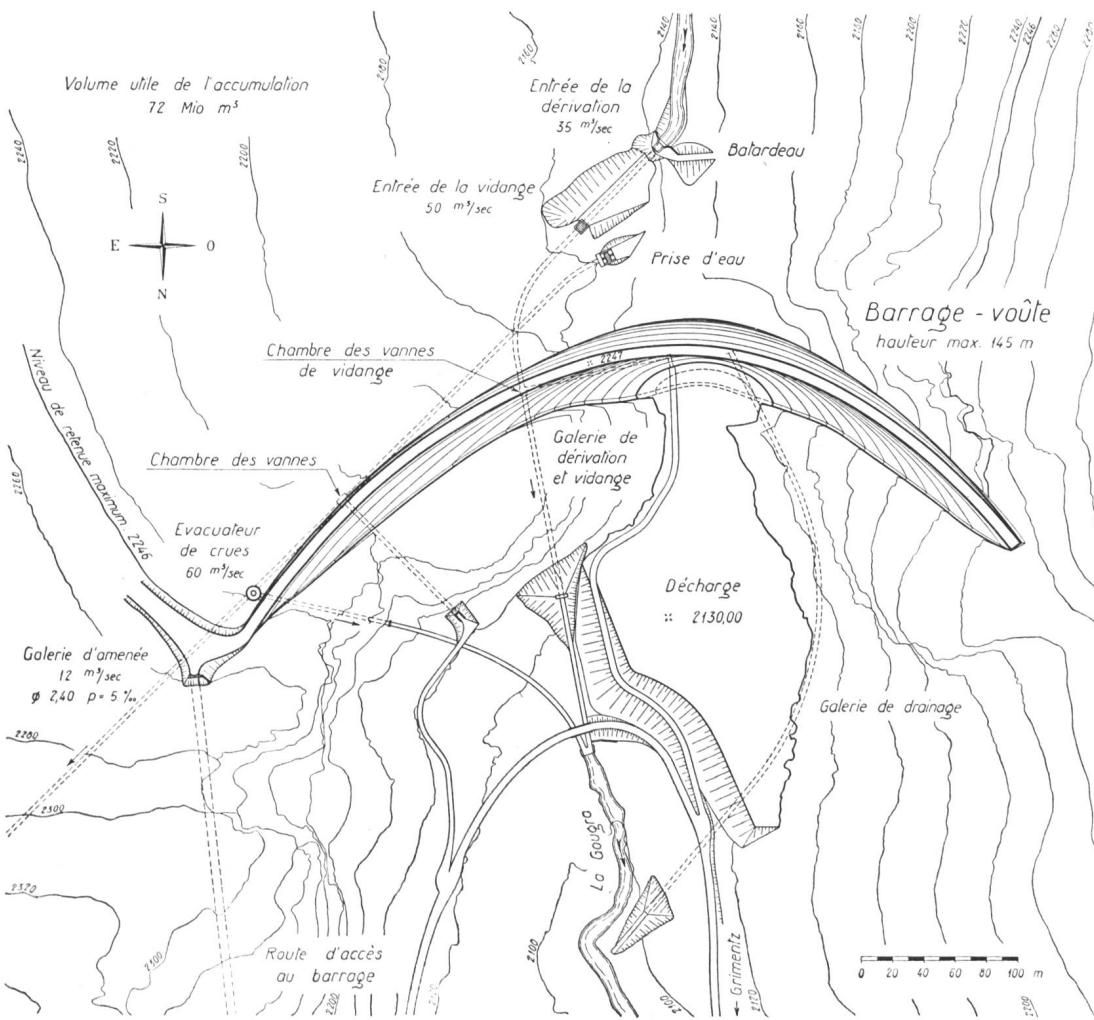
Staumauer Moiry, Lageplan 1:5000
